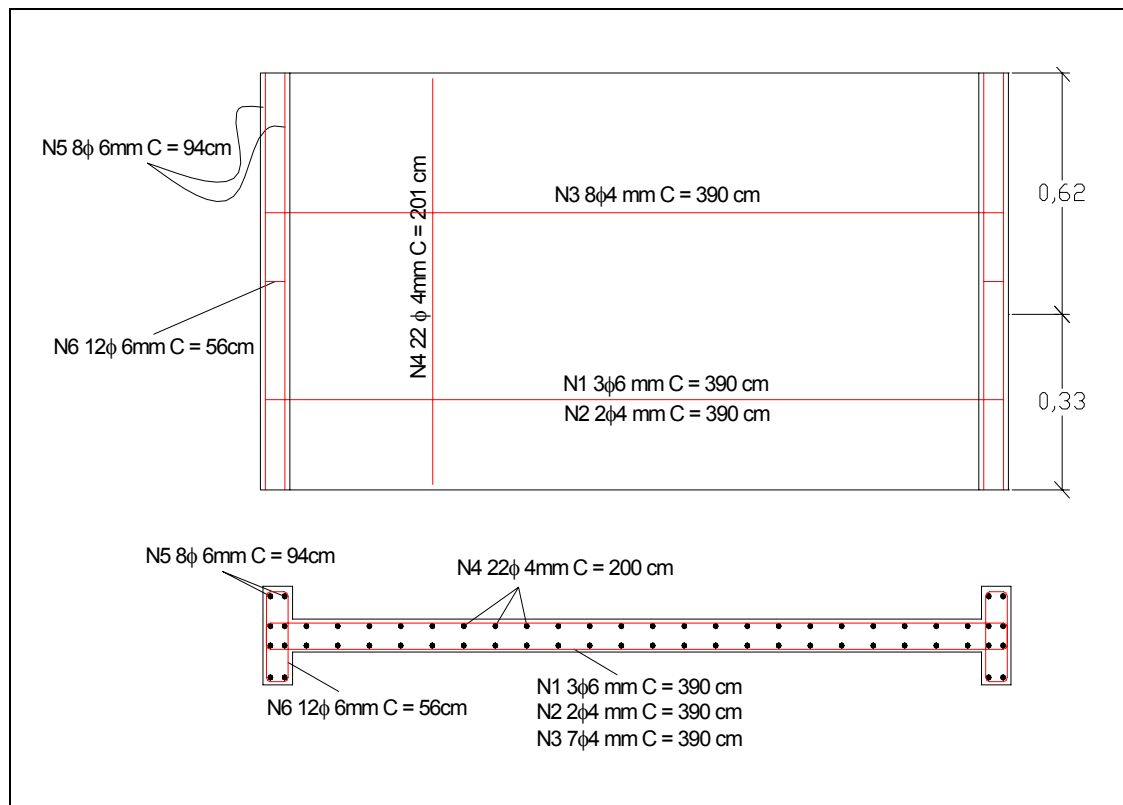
Detalhamento final da viga-parede para experimentação
